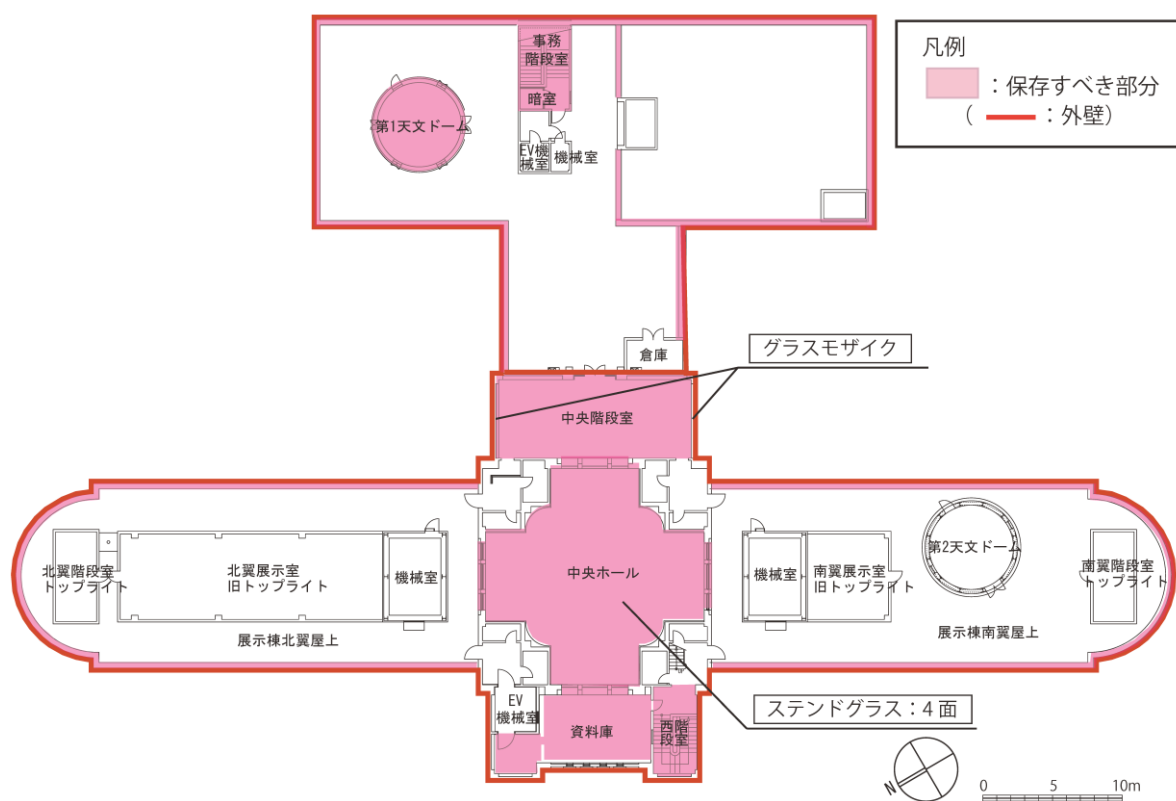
保存すべき部分 塔屋平面図（改修前 4 階平面図に加筆）
